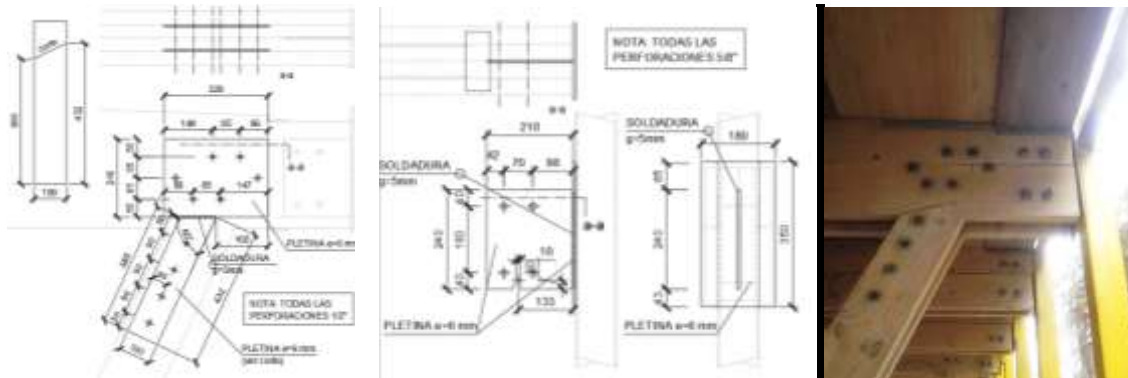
Configuración de uniones de viga principal: encuentro viga principal- tirante-diagonal y viga principal-parrilla metálica. Notar protección entre carpeta superior y viga.
